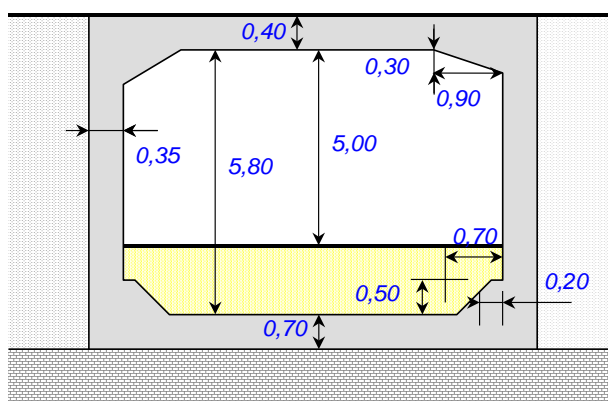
Coupe longitudinale biaise de l'ouvrage
